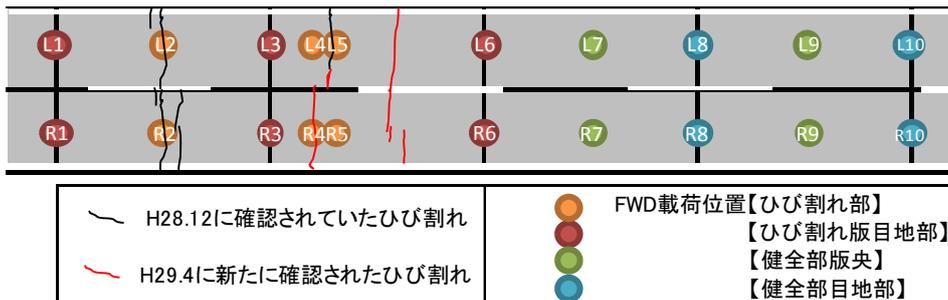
FWD 調査位置および Co 版のひび割れ発生状況
